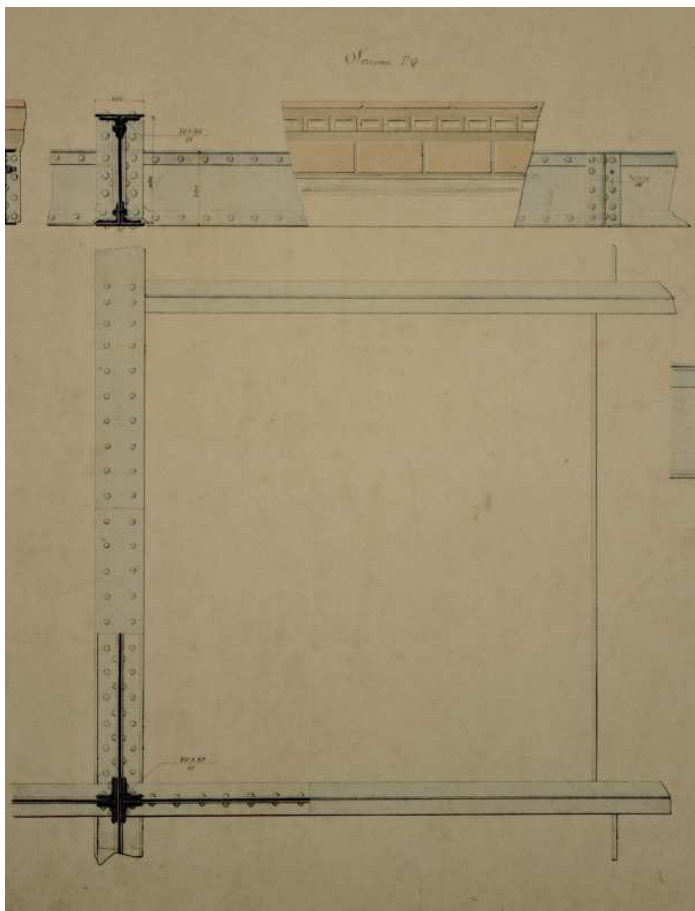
Dettagli delle travature dei bracci longitudinali, pianta e sezione PQ
